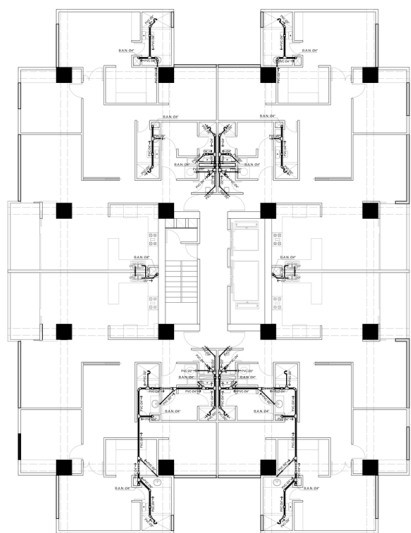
Planta que destaca la concentración de la instalación de red de drenaje sanitario, lo que ayuda a mantener una menor altura de piso a piso.
